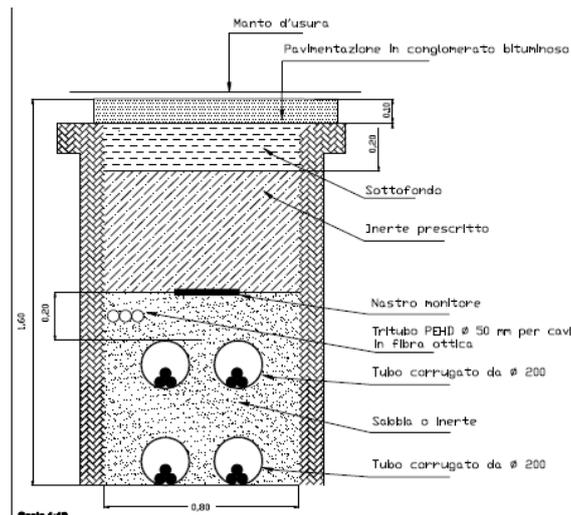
Sezione su strada asfaltata - posa di n°4 cavi MT
